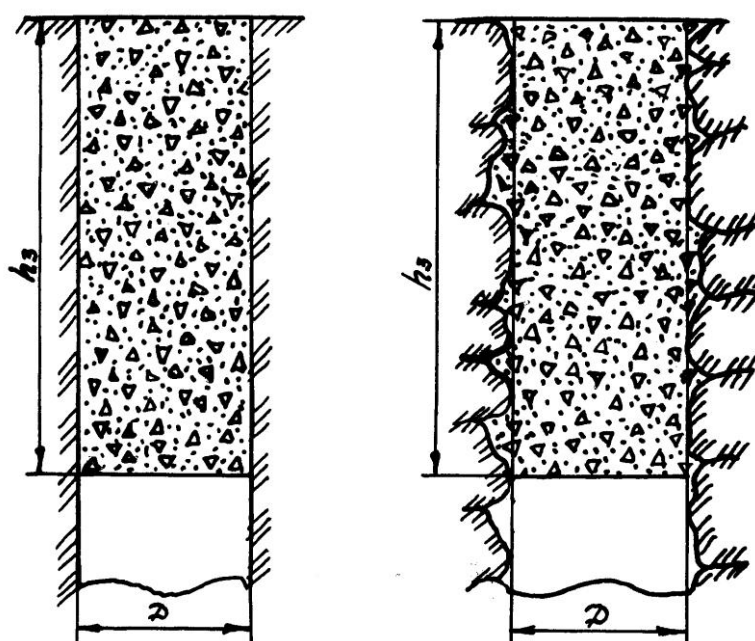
Бетонная забойка: *а* – в скважине с гладкими ровными стенками; *б* – в скважине с вывалами и трещинами в стенках
